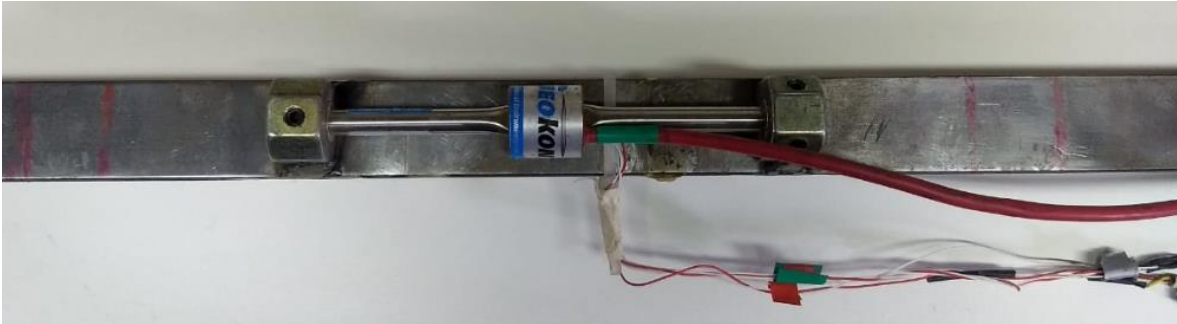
Instrumentación superior de la barra tipo 01, se aprecian las etiquetas verdes
